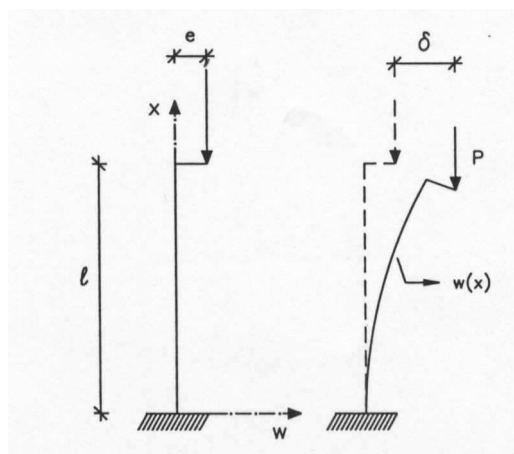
Pilar submetido à carga de compressão excêntrica.
